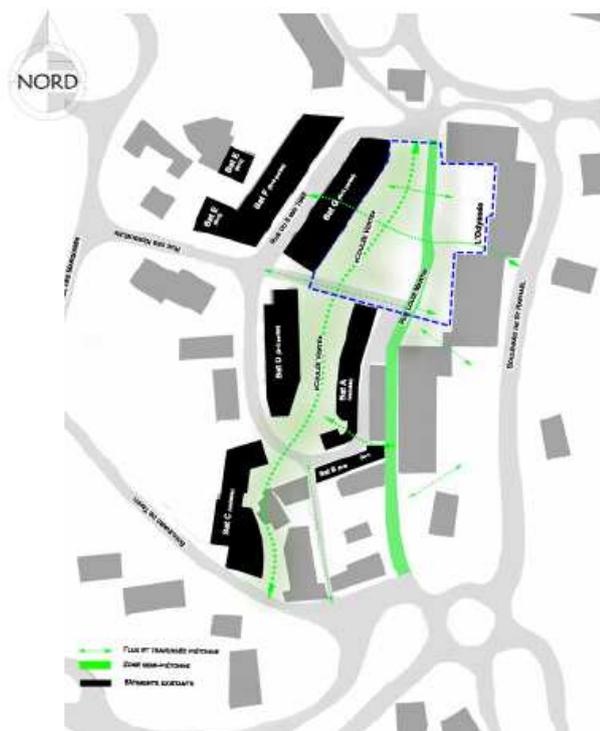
Plan de masse général du projet (mairie intégrée au bâtiment G)
